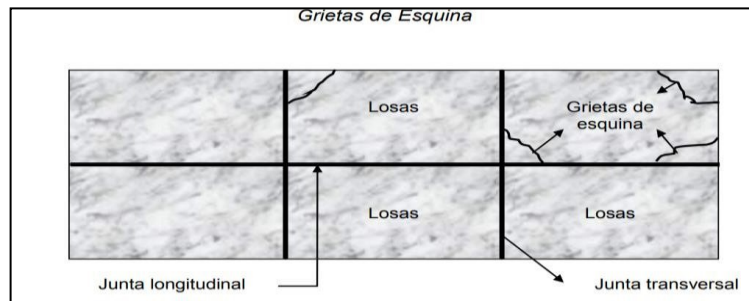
Falla por fisura en esquina de Pavimento Rígido
